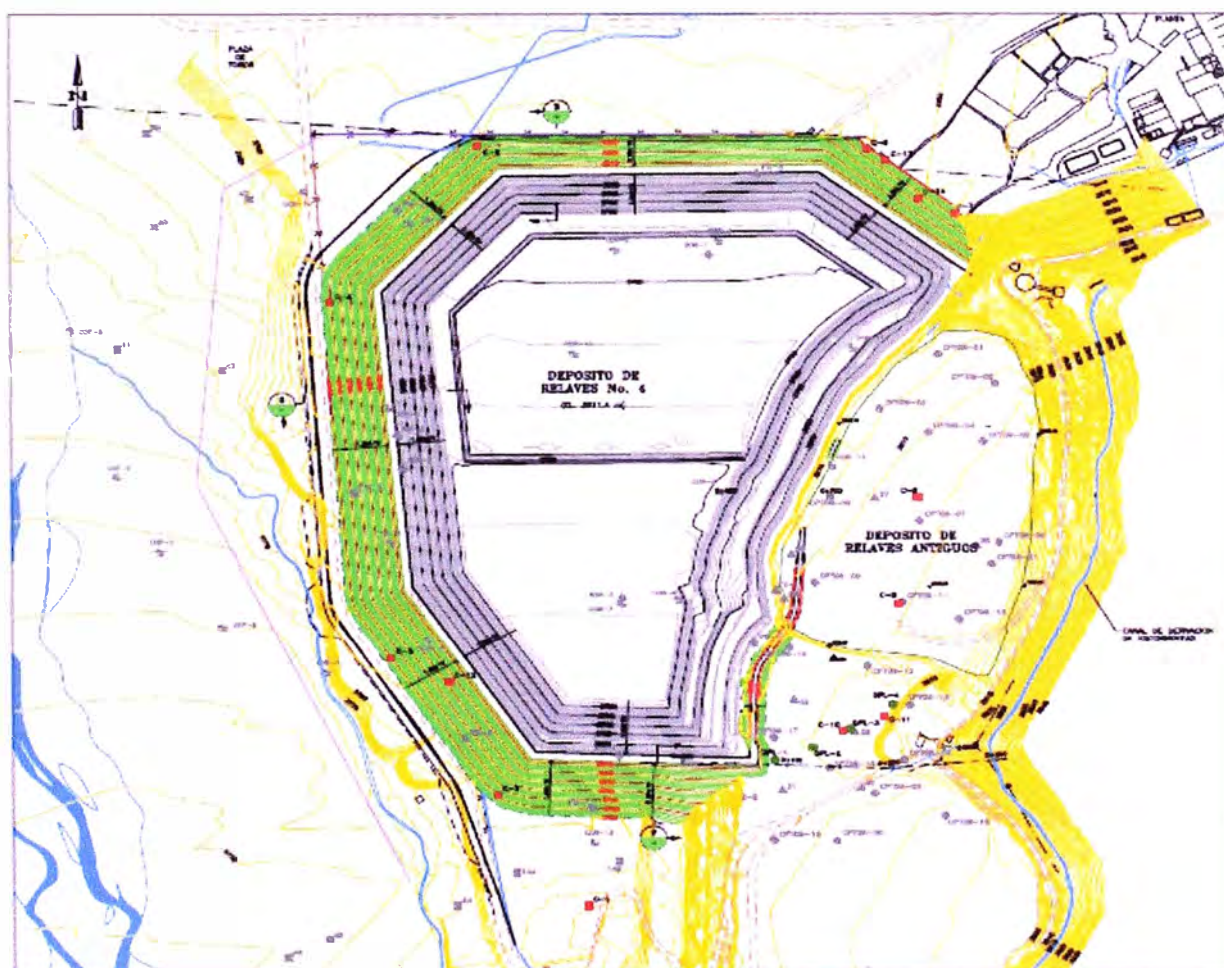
Ubicación en planta de las secciones típicas para los análisis de infiltración y estabilidad.
